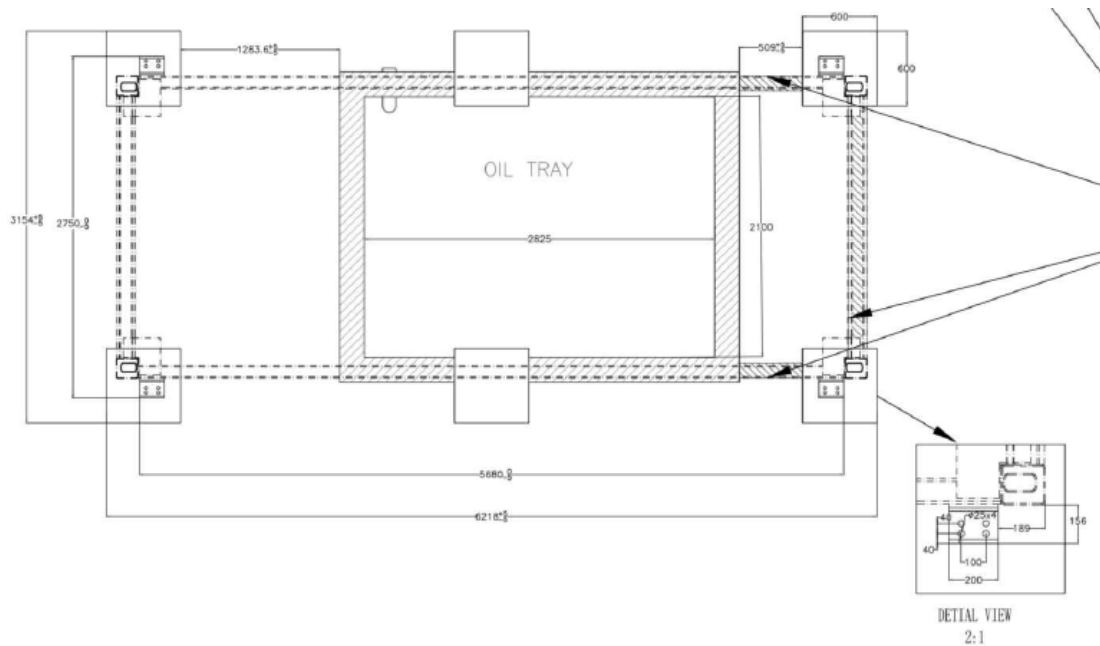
Vista in pianta fondazioni cabina di trasformazione
